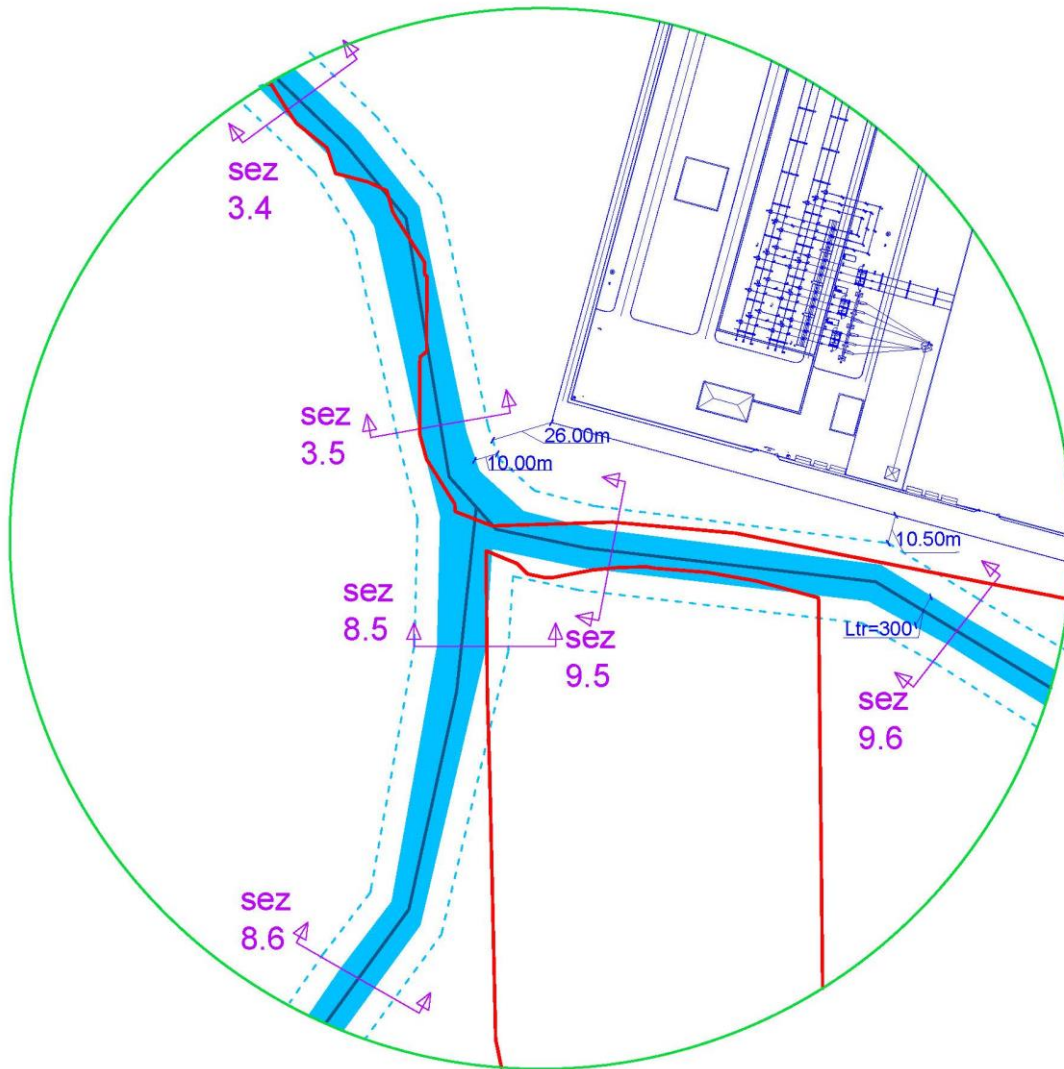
b - Dettaglio zone di inondazione con sovrapposizione dell'area di interesse - Stazione Rete - Utente
